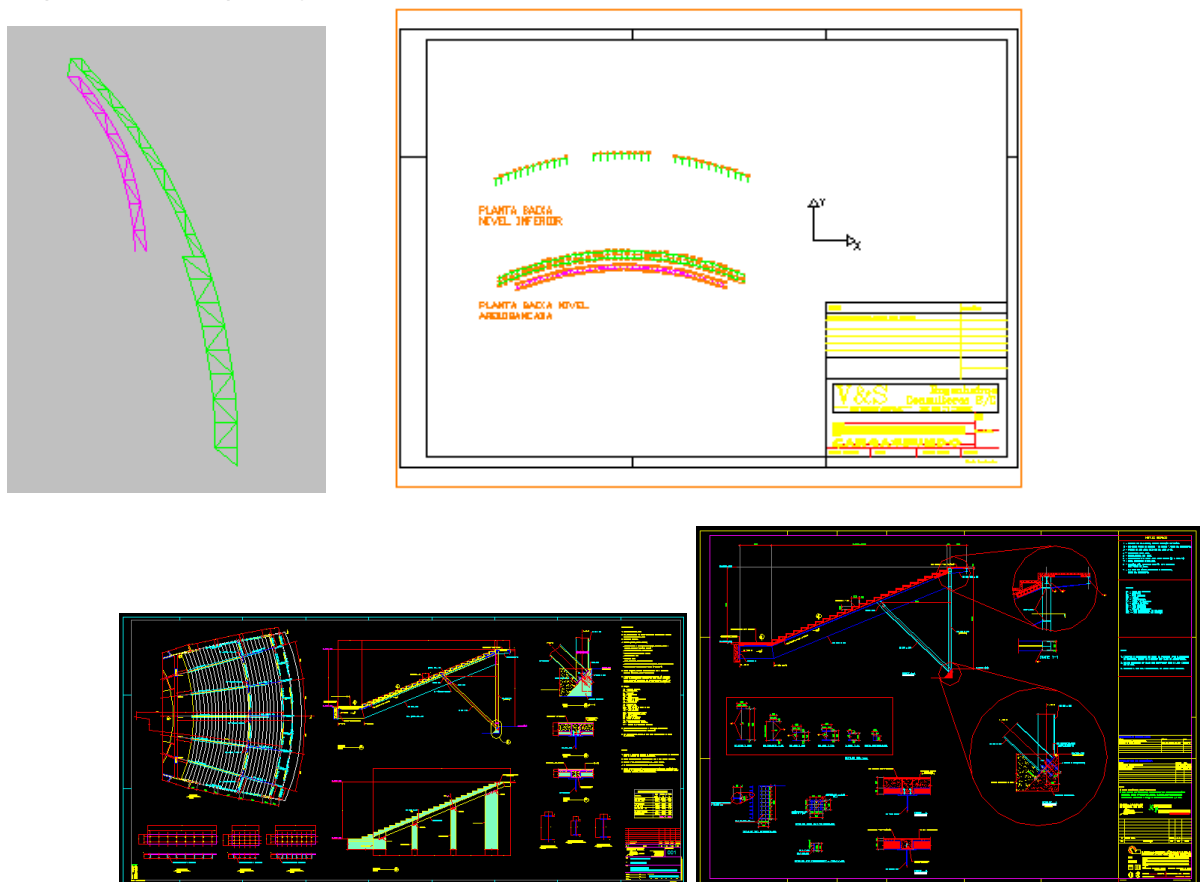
Painel 5 – Mosaico apresentando: a) fundação para fixação da mão francesa; b) mãos francesas e detalhe das colunas laterais em concreto (suporte para fechamento perimetral); c) vigas inclinadas de suporte à pré-laje da arquibancada superior
